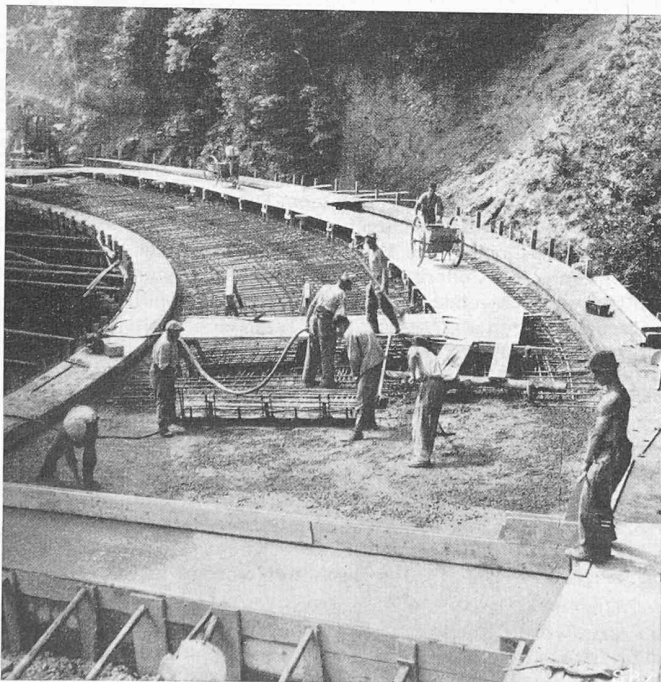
Betonieren der Fahrbahnplatte (Vibropil)
